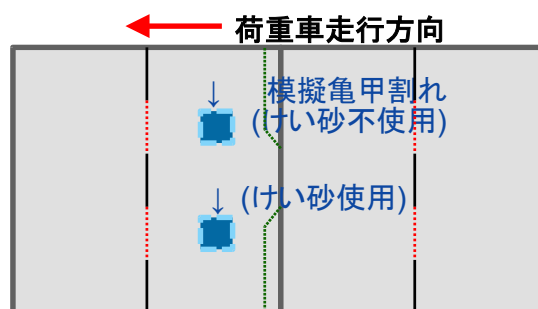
模擬亀甲ひび割れ位置
